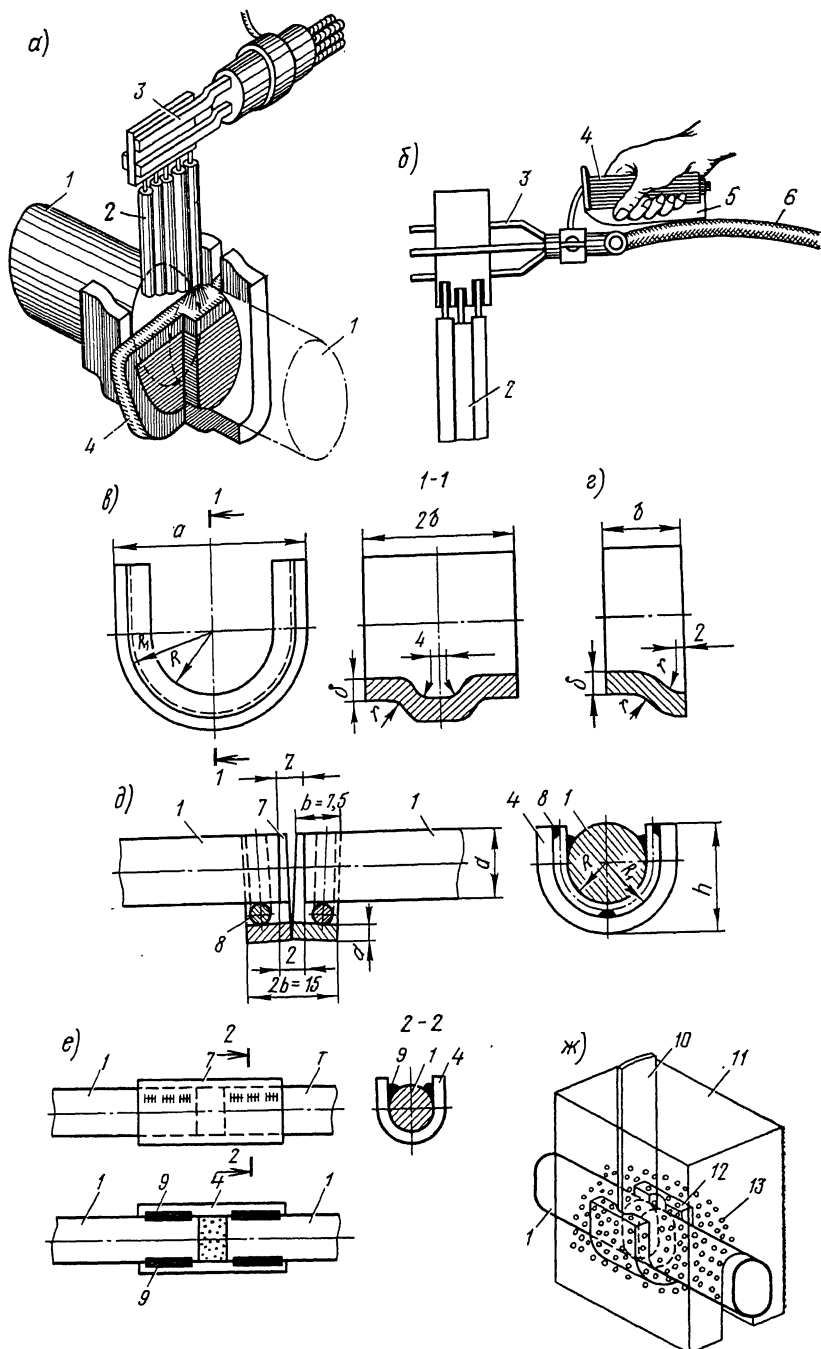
Схемы соединения стержней ванной сваркой
